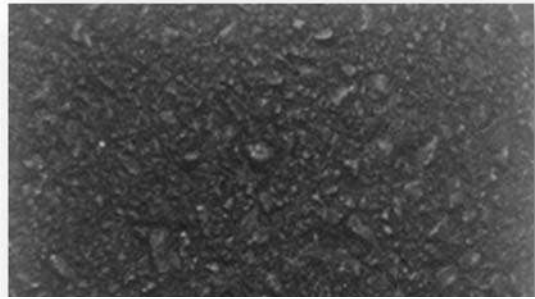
Mezcla asfáltica de granulometría densa puesta en un pavimento.
